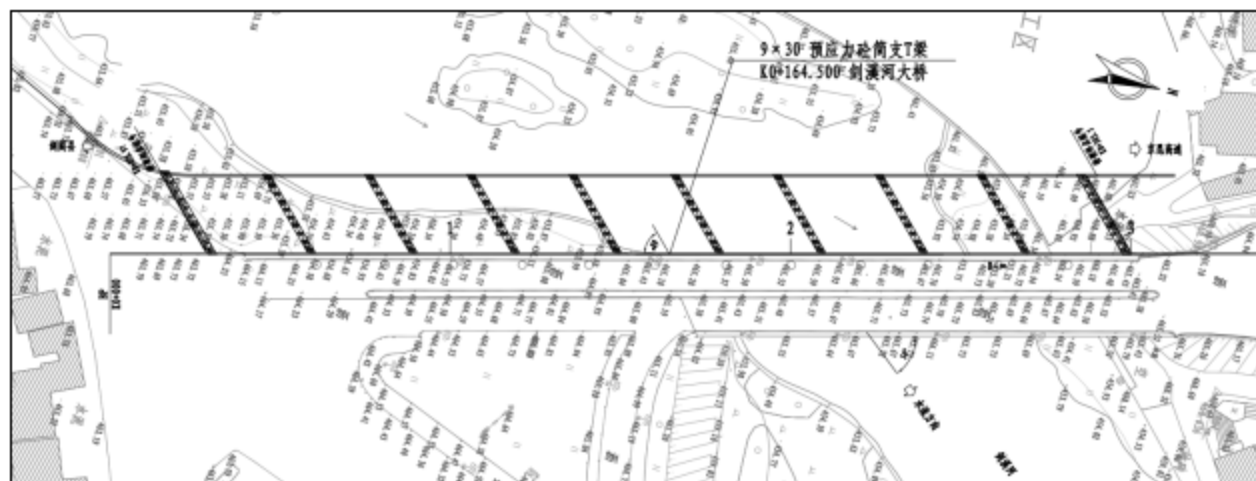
剑溪河大桥新建左半幅桥梁桥位平面图
